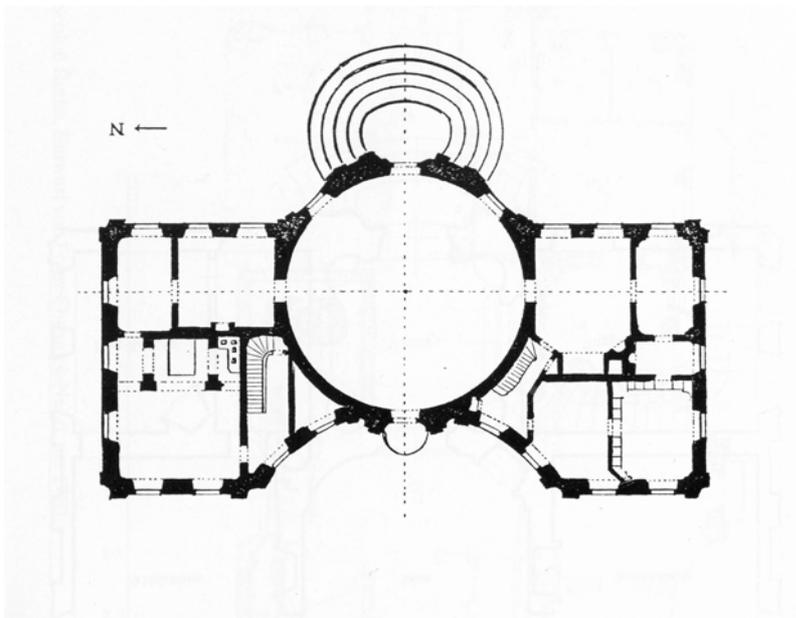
Grundriss des Jagdschlösschens Amalienburg, München, erbaut 1734-1739 nach den Plänen des Architekten Francois de Cuvillies d. Ä. als eingeschossiger Rokokobau für die Kurfürstin Amalie, einer Tochter Josephs I.; nach einem Plan um 1800
